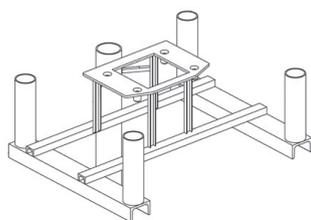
Basamento opi2020 e predisposizione di un punto di ricarica in cui il basamento è stato inglobato nella fondazione di cemento armato. I tubi consentono una facile installazione degli archi di protezione e del cartello segnaletico. L'utilizzo di opi2020 implica che la stazione di ricarica abbia una piastra di fissaggio con interassi fra i fori compatibili. Una stazione che non abbia questa caratteristica può essere installata usando una piastra intermedia di adattamento oppure disegnando un basamento su misura.
